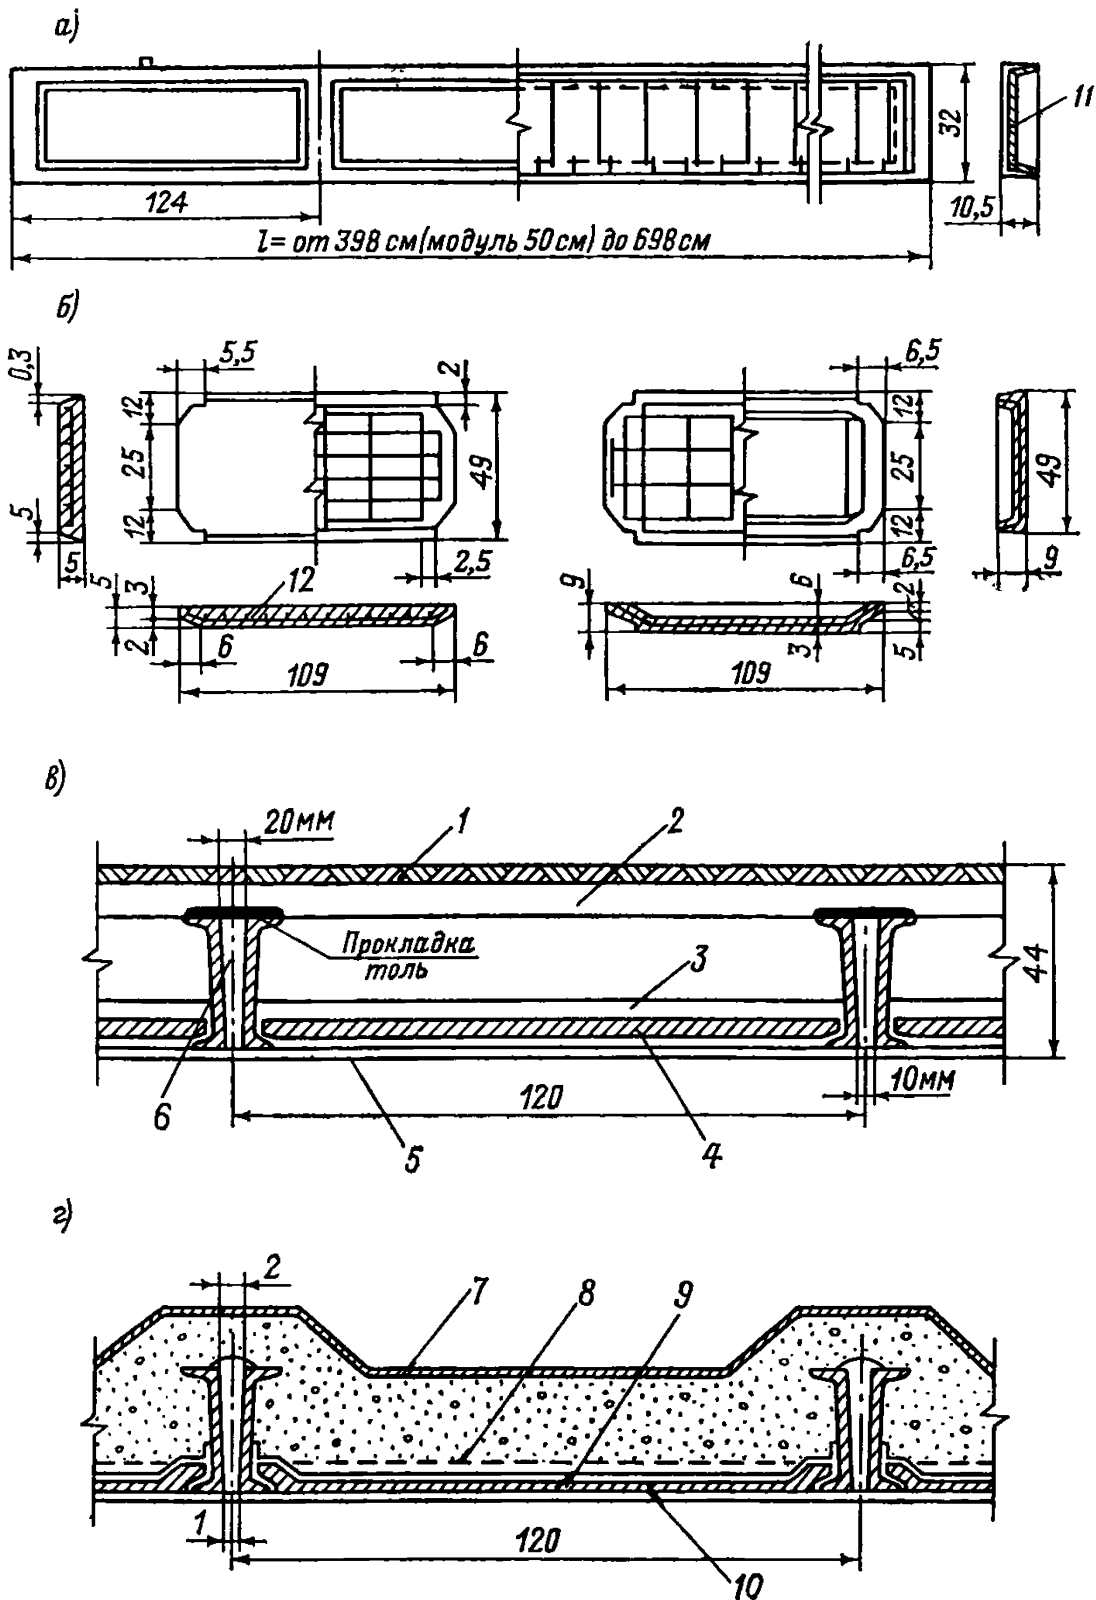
Конструкции перекрытия по балкам швеллерного сечения
